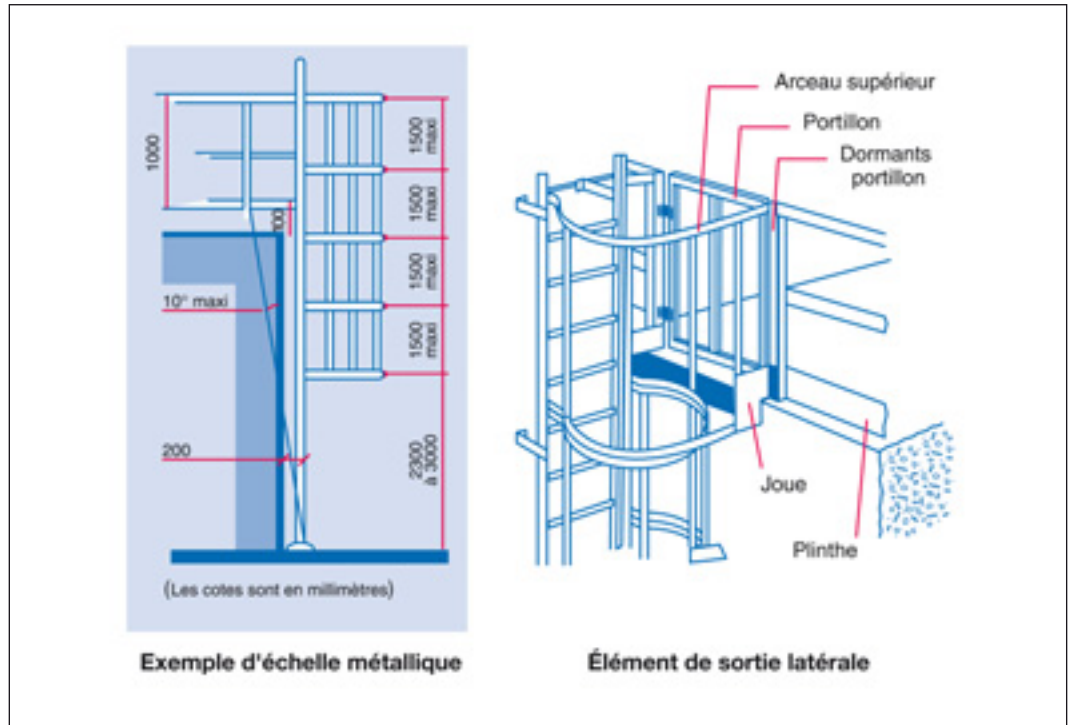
Exemples de construction d'une échelle métallique à crinoline.
